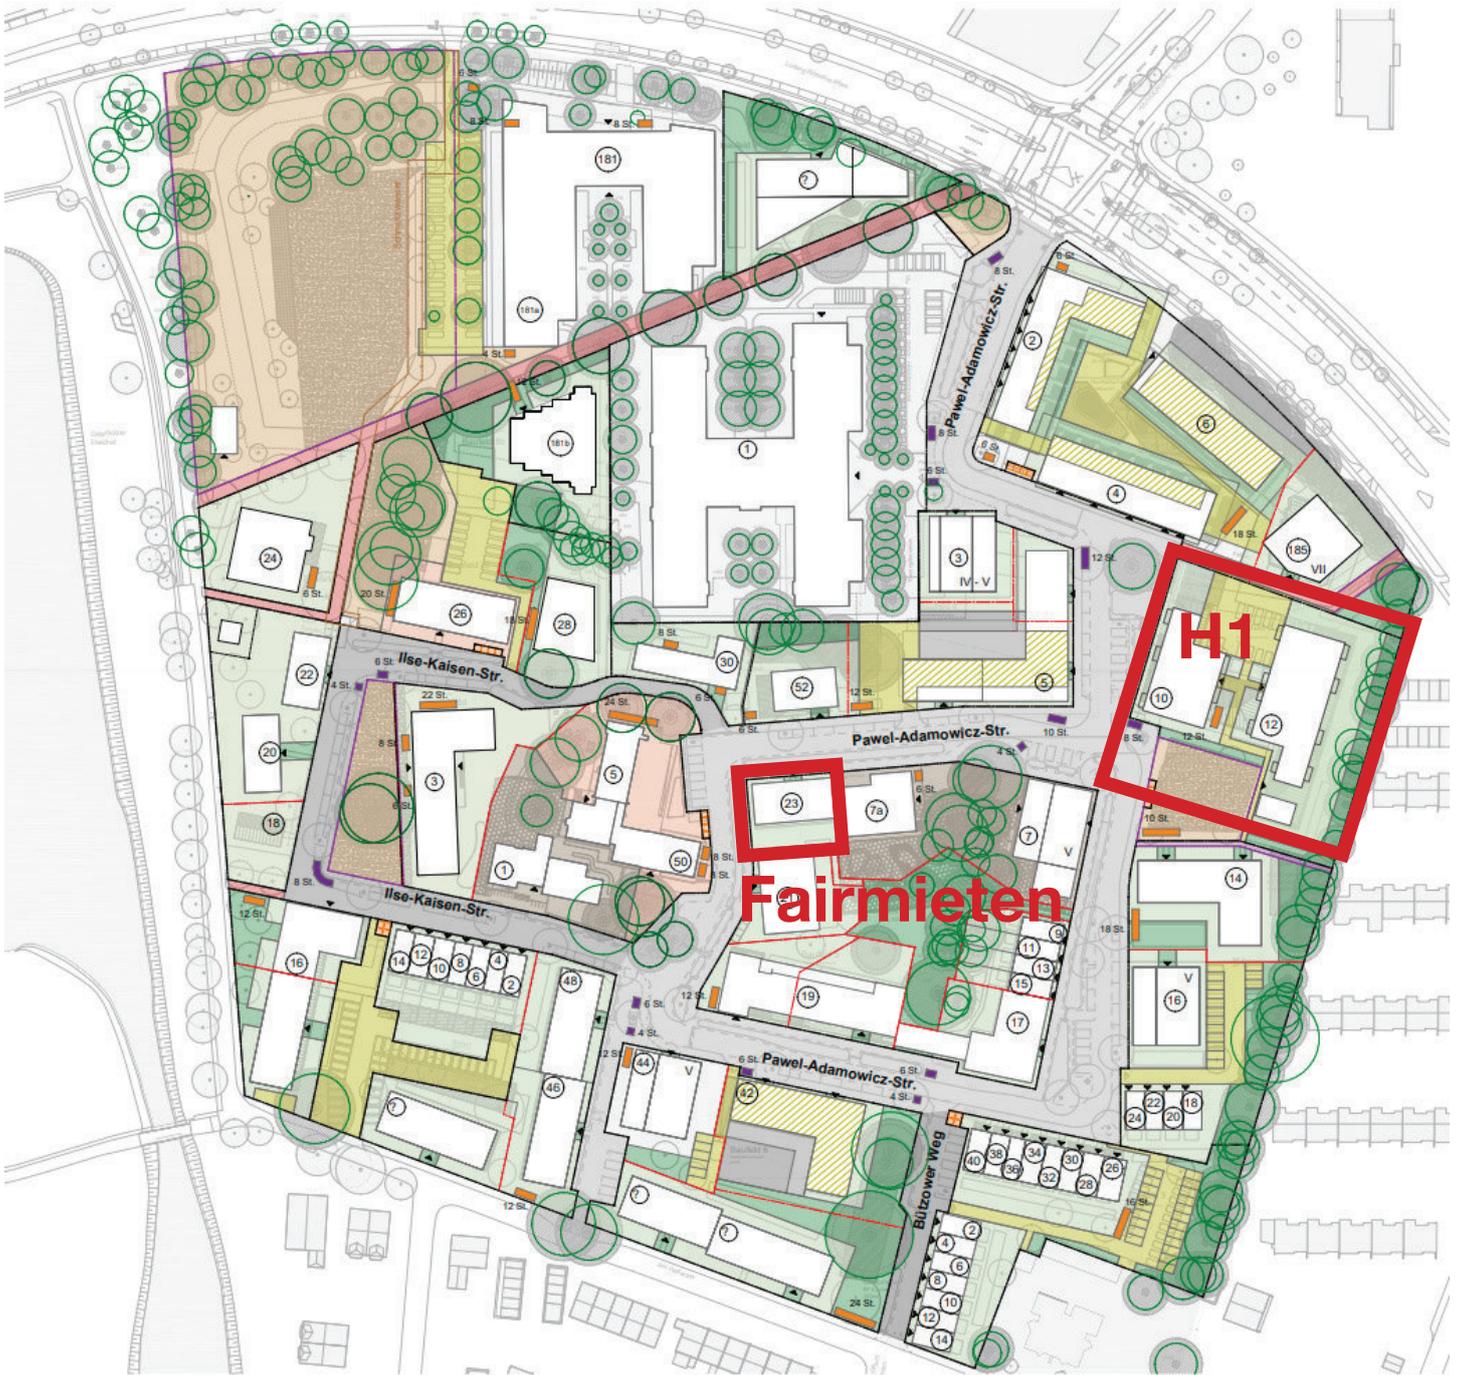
Ellerner Hof, Lageplan ohne Maßstab
